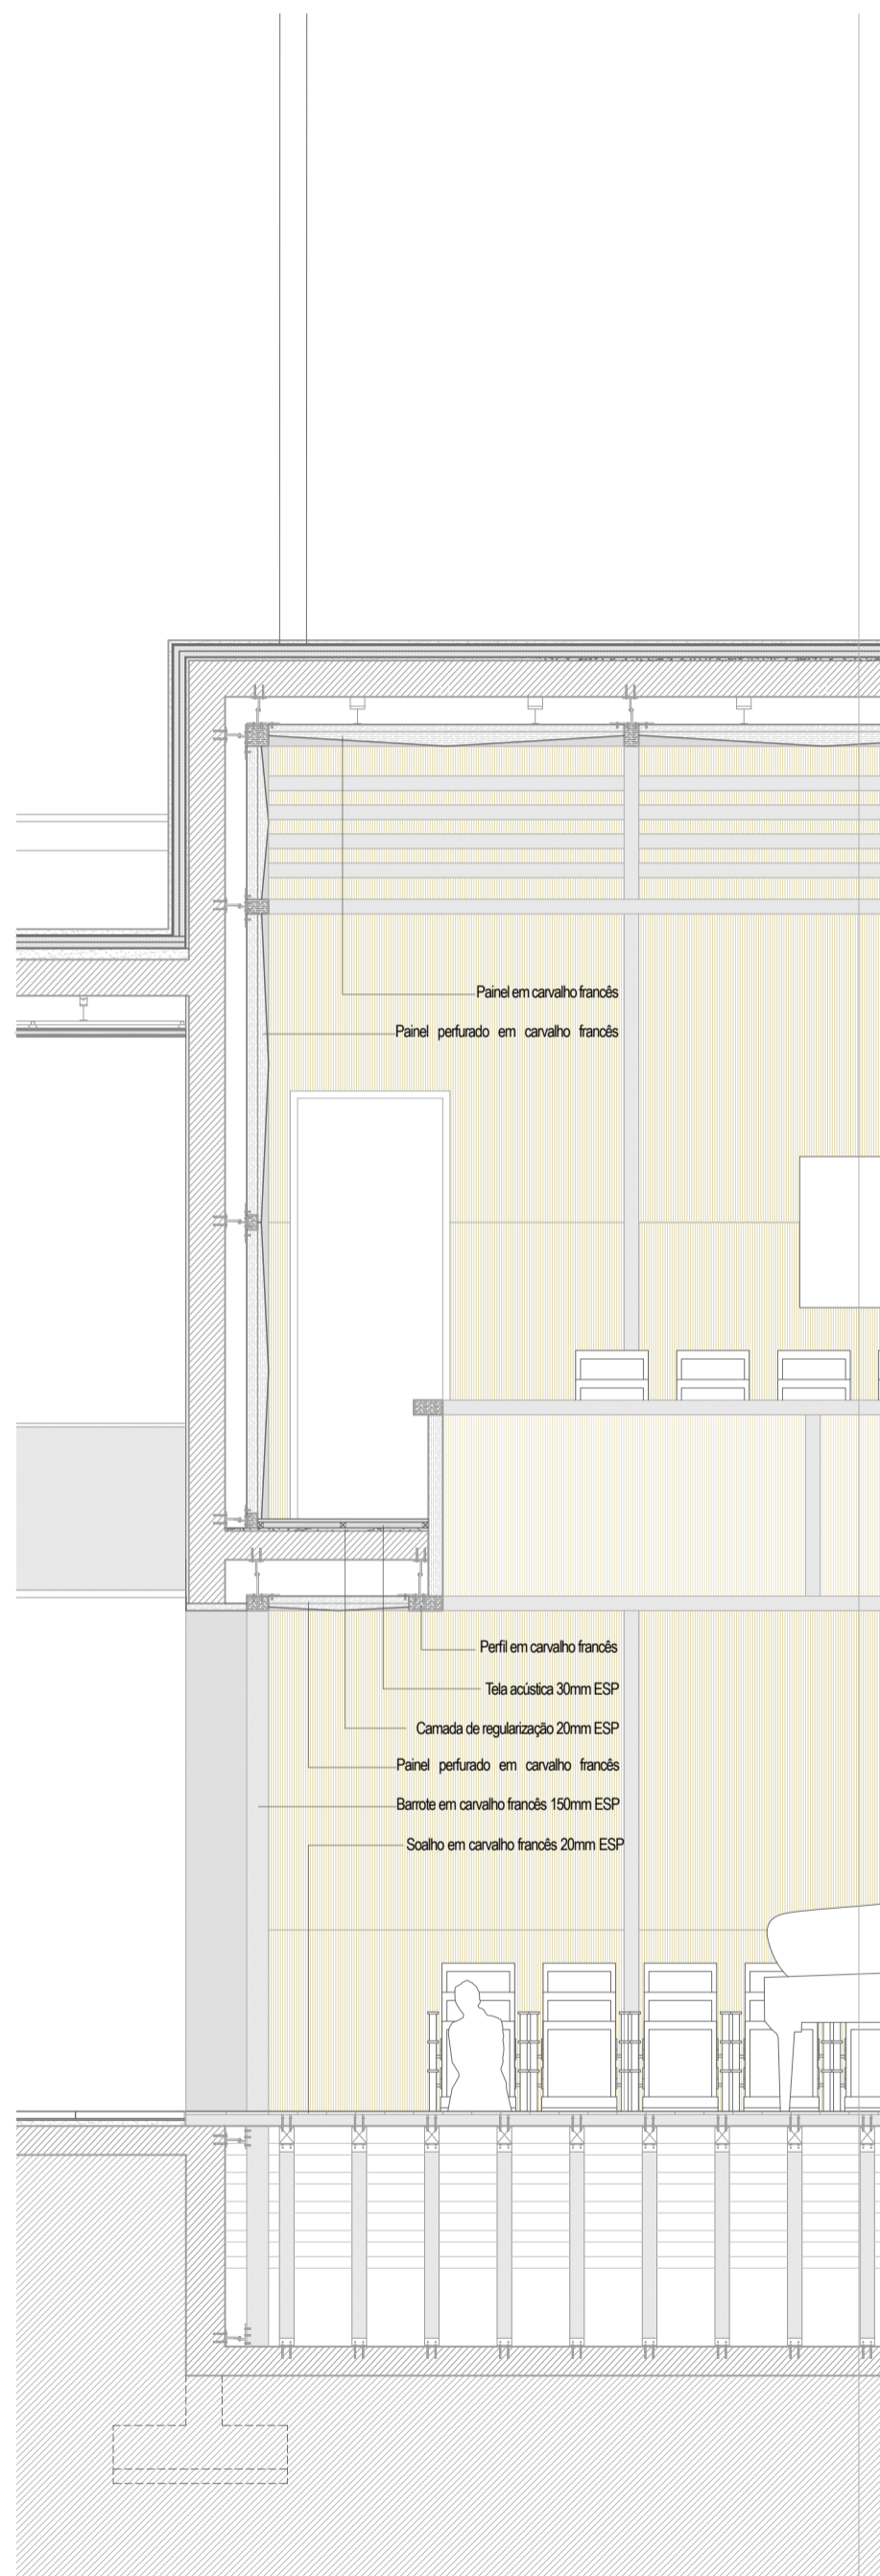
Corte transversal pormenor construtivo, desenho do autor.
